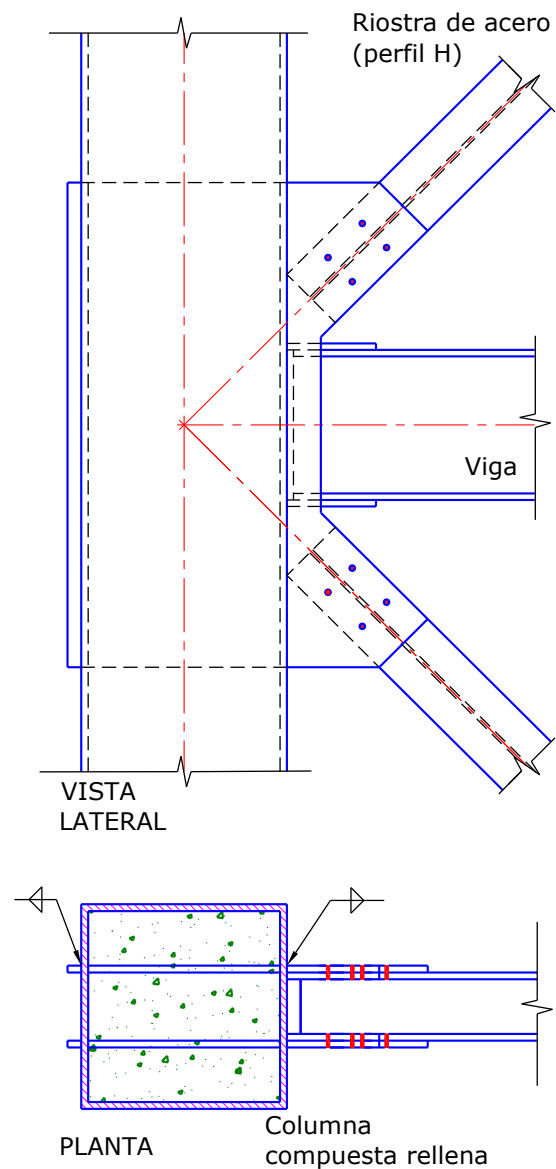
Detalle de una conexión de riostras y viga a una columna compuesta rellena.
